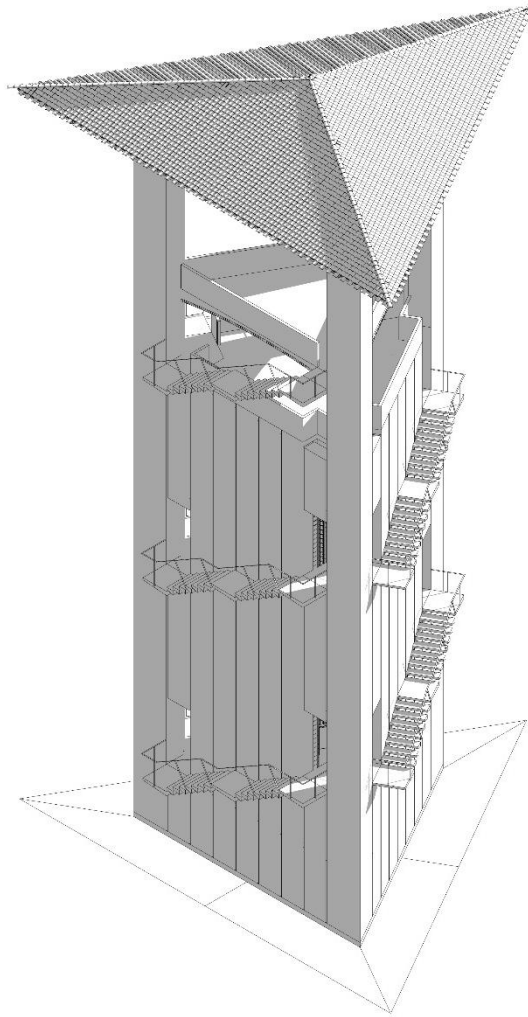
Perspective noir et blanc, vue d'ensemble de la tour
